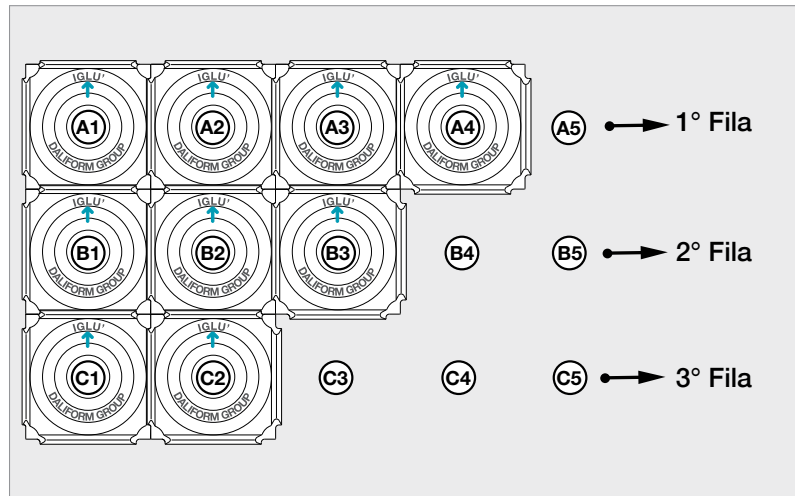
Sequenza di posa a secco degli elementi per righe.
